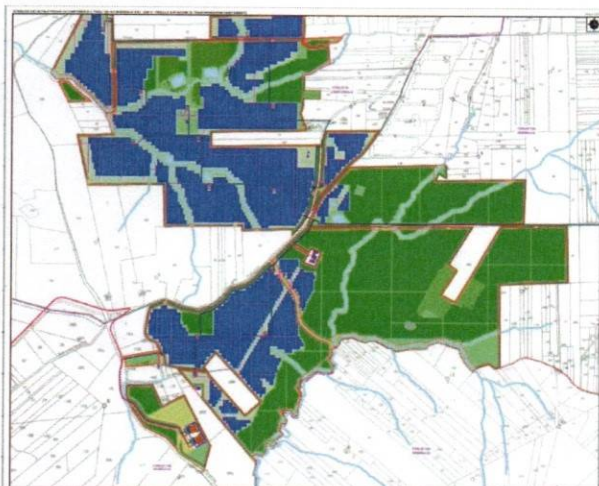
Elaborato di progetto “Nuovo layout Pizzillo”
